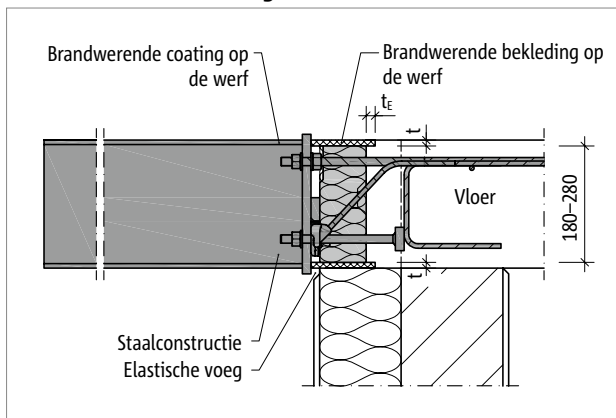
Schöck Isokorb® T type SK-MM2-VV1: Doorsnede
